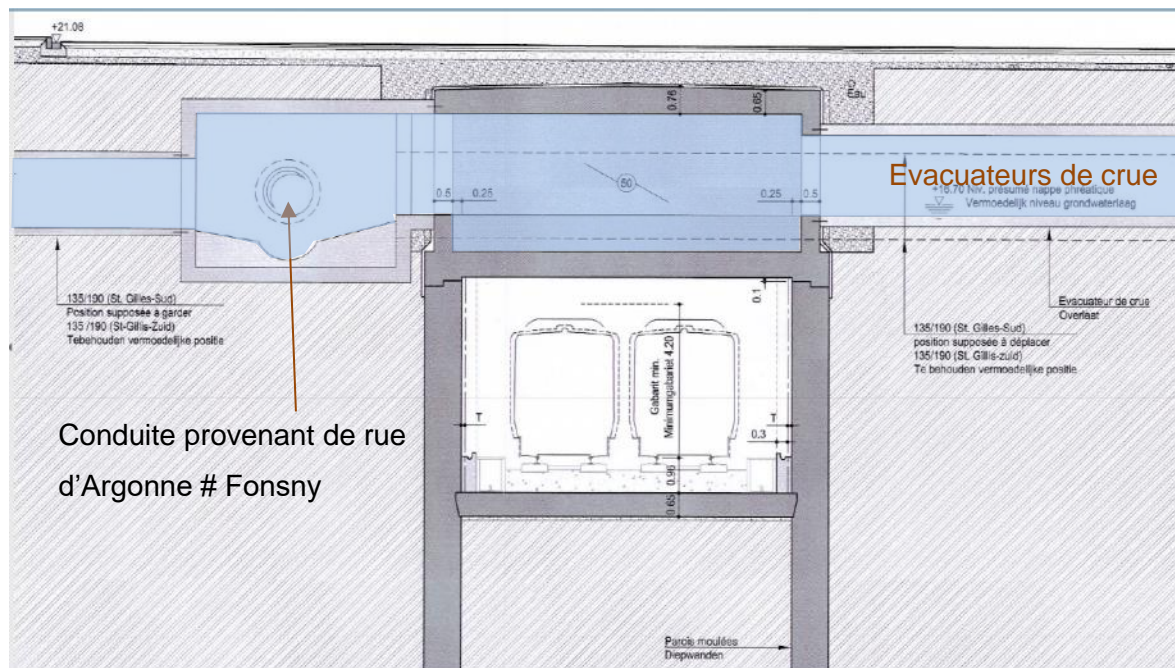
Coupe transversale au niveau du croisement Fonsny # Boulevard du Midi (source : demande de PU)
